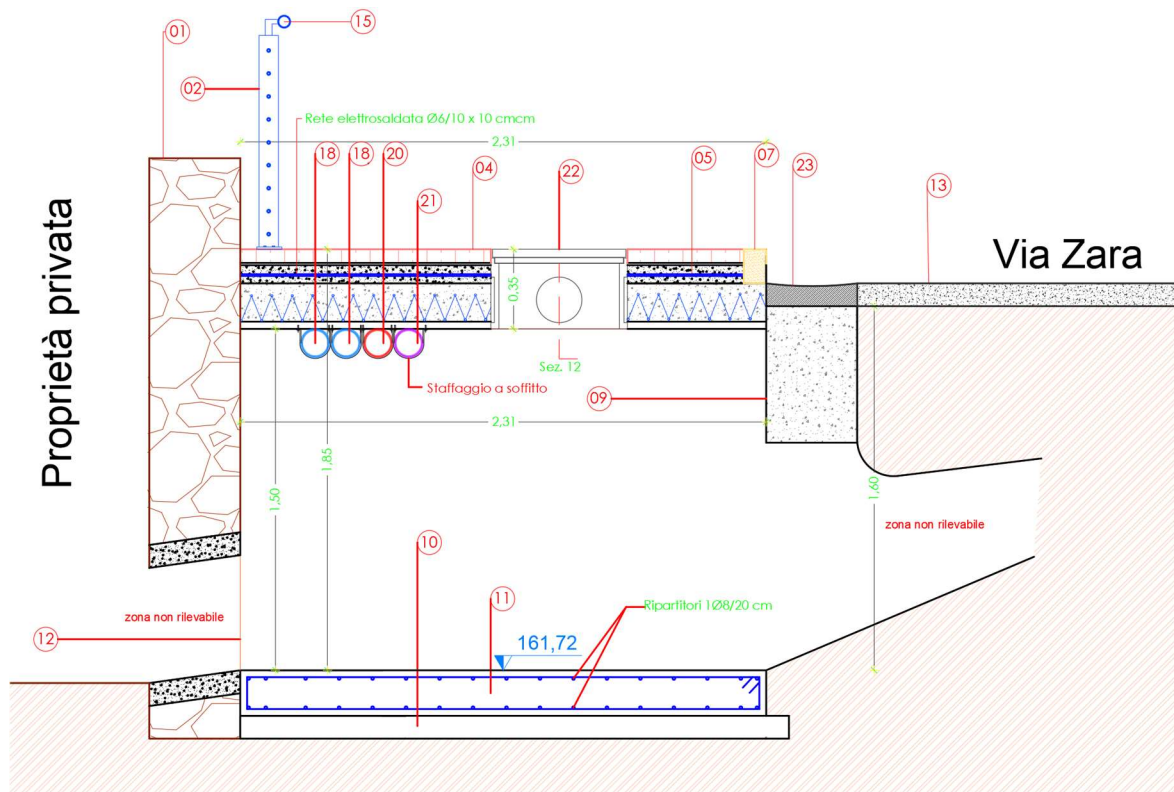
Sezione di dettaglio dello scatolare in c.a. (tratto 4.a.)
